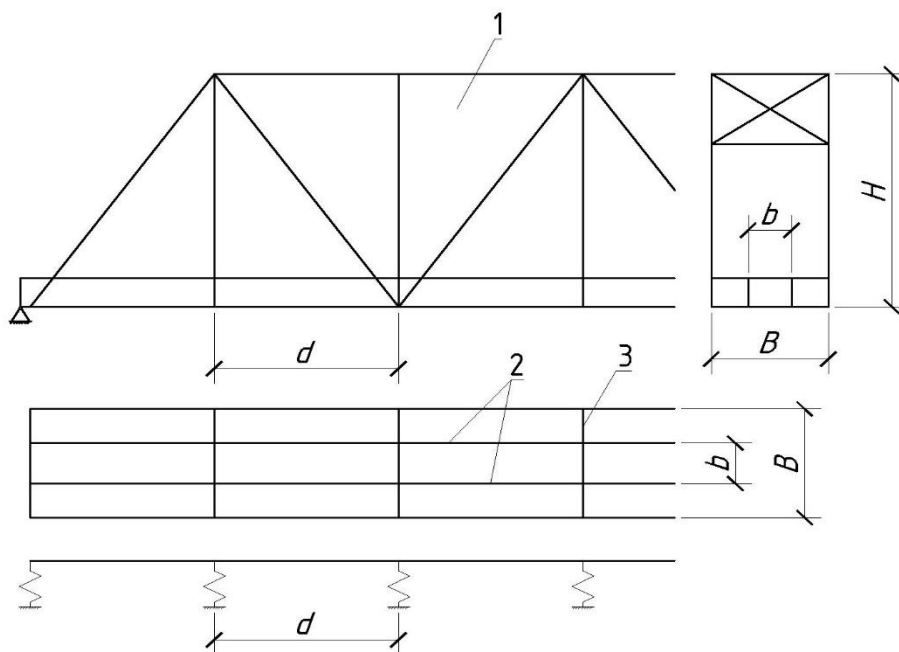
Схема до розрахунків балок проїзної частини. 1 – ферма; 2 – поздовжні балки; 3 – поперечні балки
